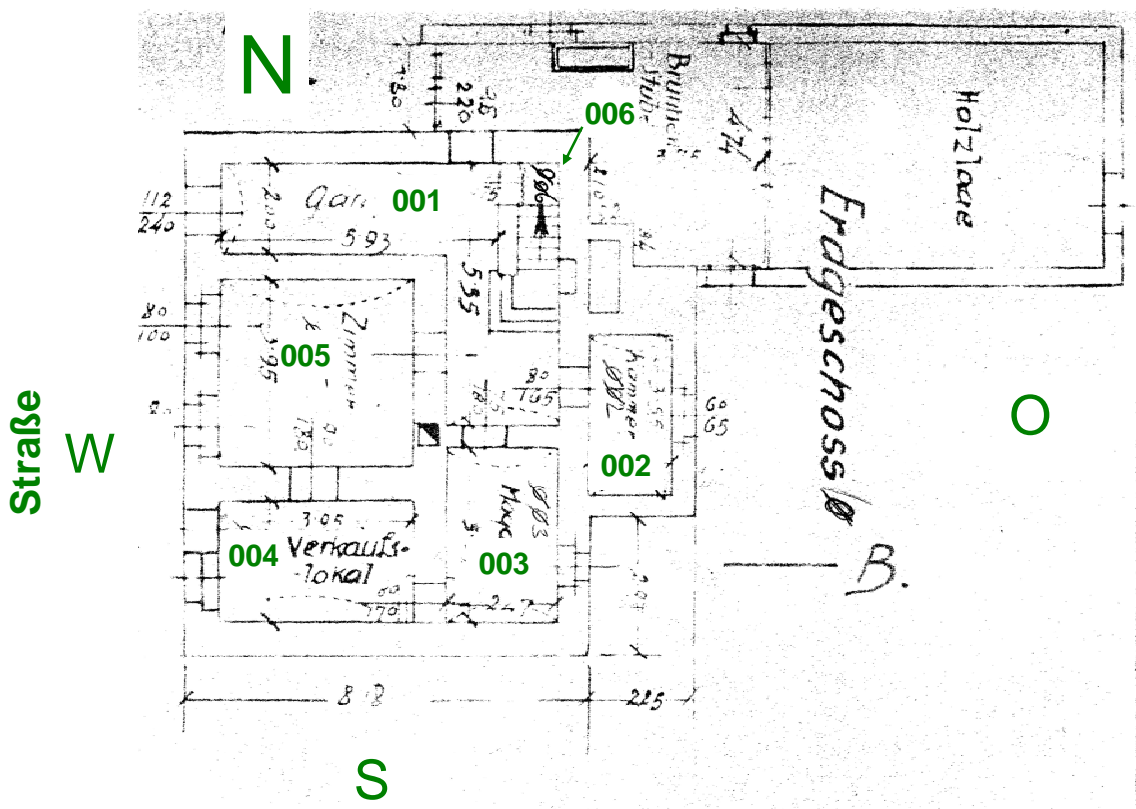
Grundriss mit Raumnummern, Erdgeschoss
